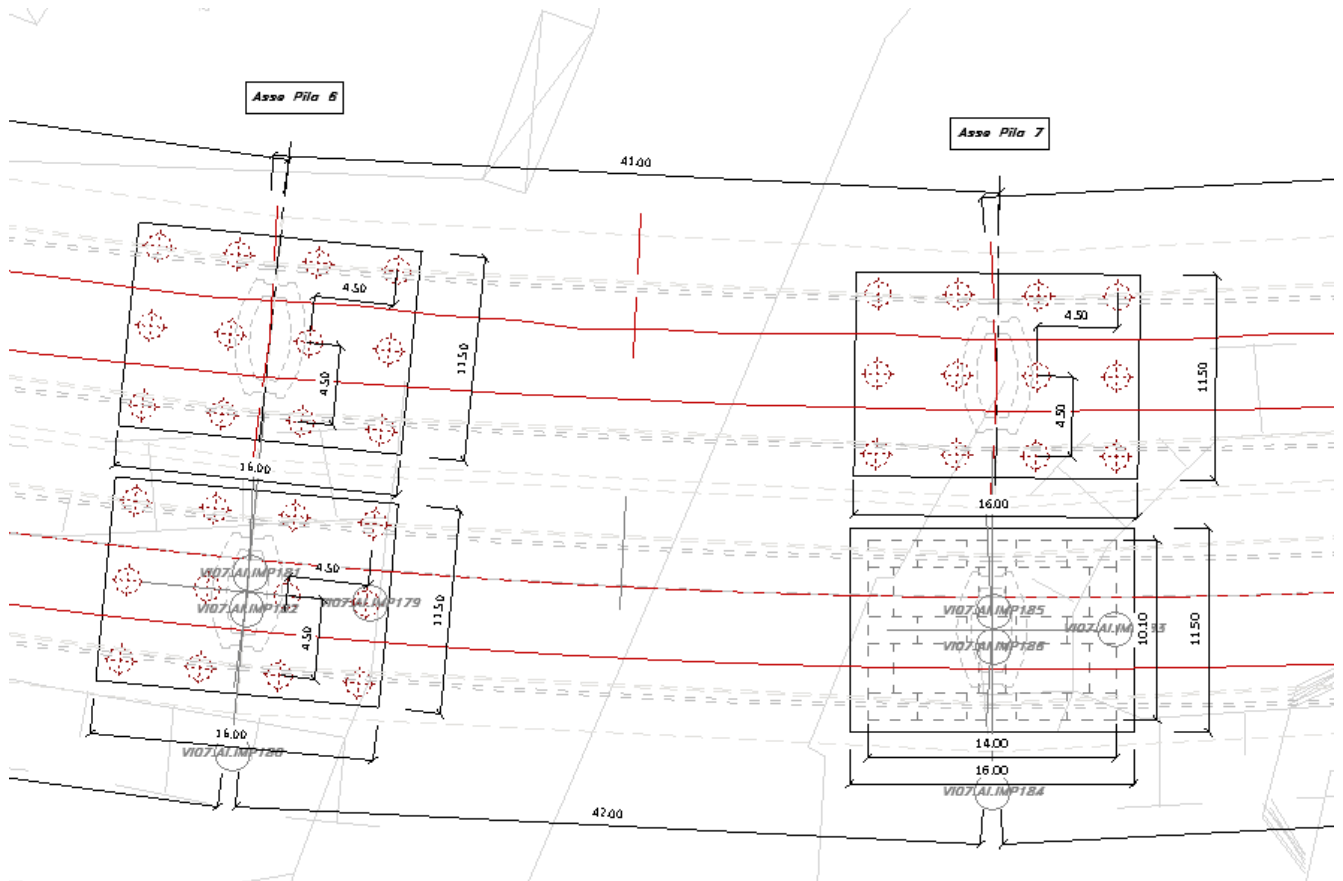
carpenteria pila e fondazioni Pile 6 e 7 VI05 e VI06
